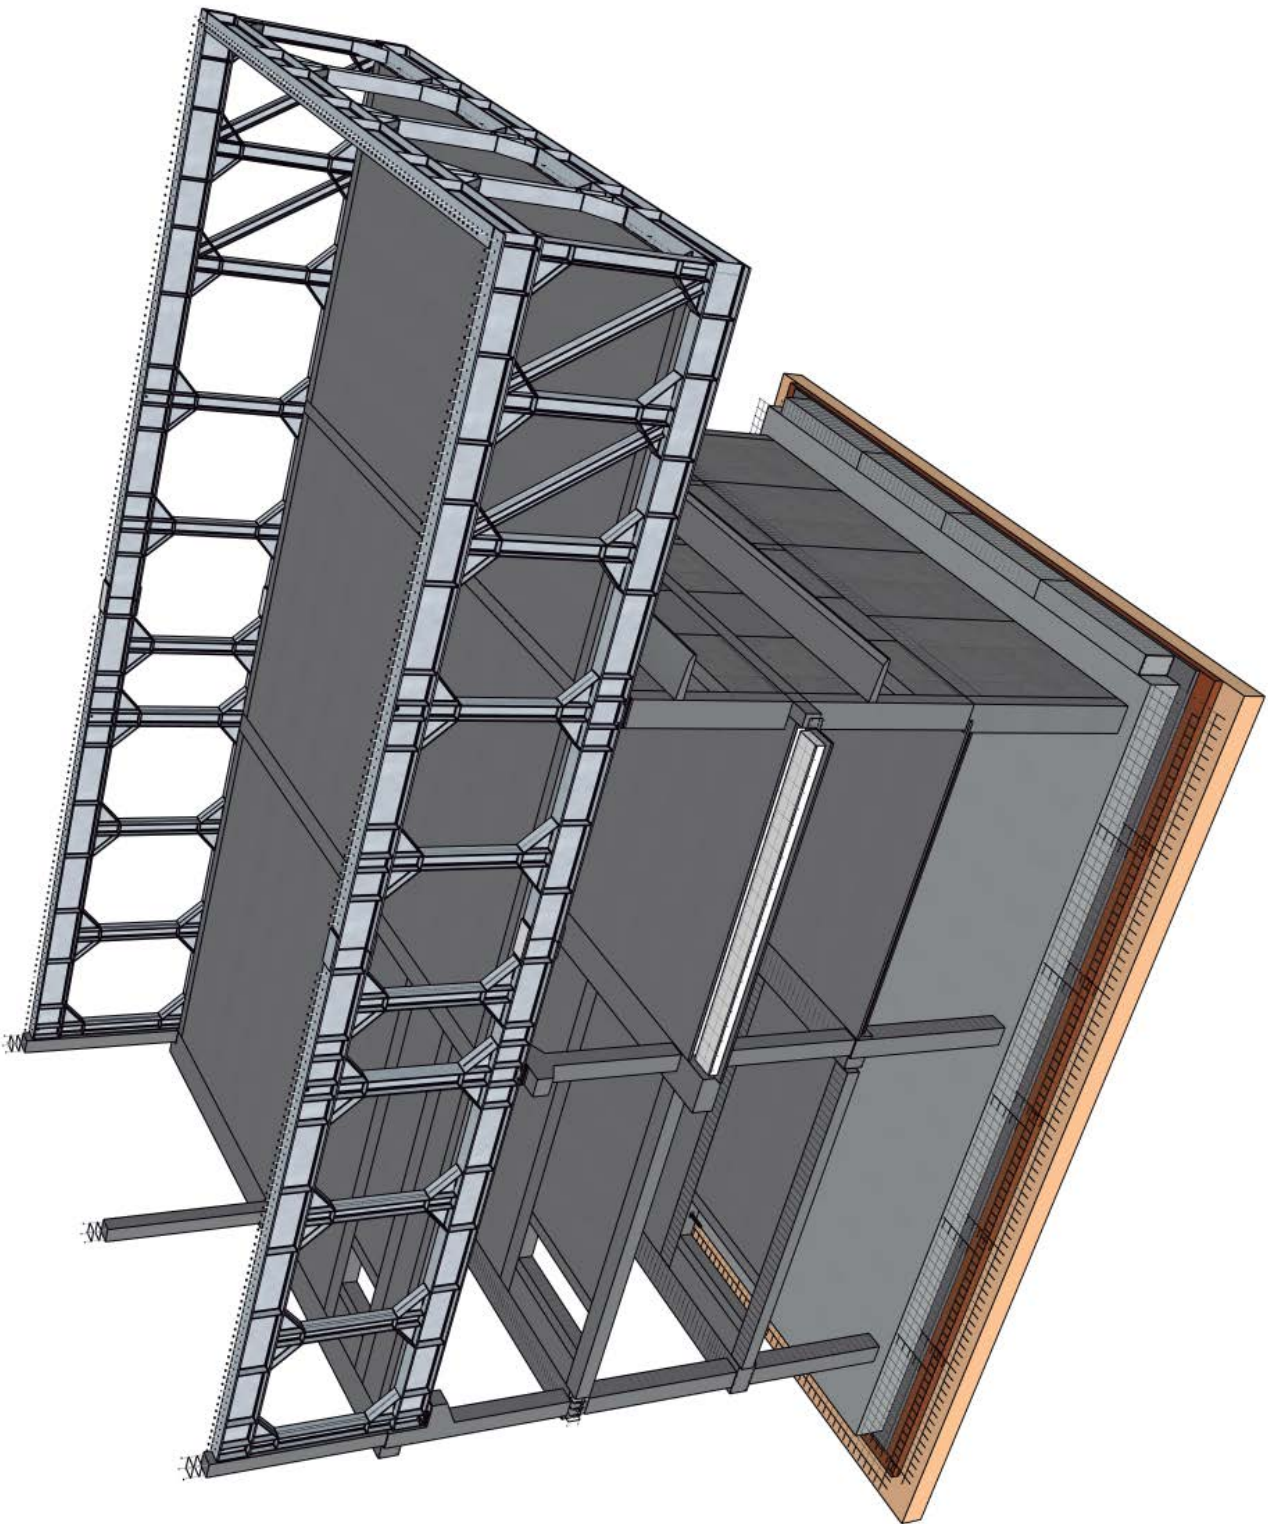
Hormigonado de las prelasas del forjado en el voladizo
